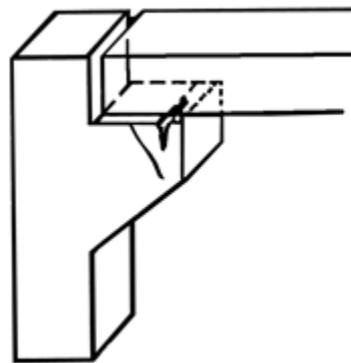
Fisuras por retracción hidráulica en ménsula.
